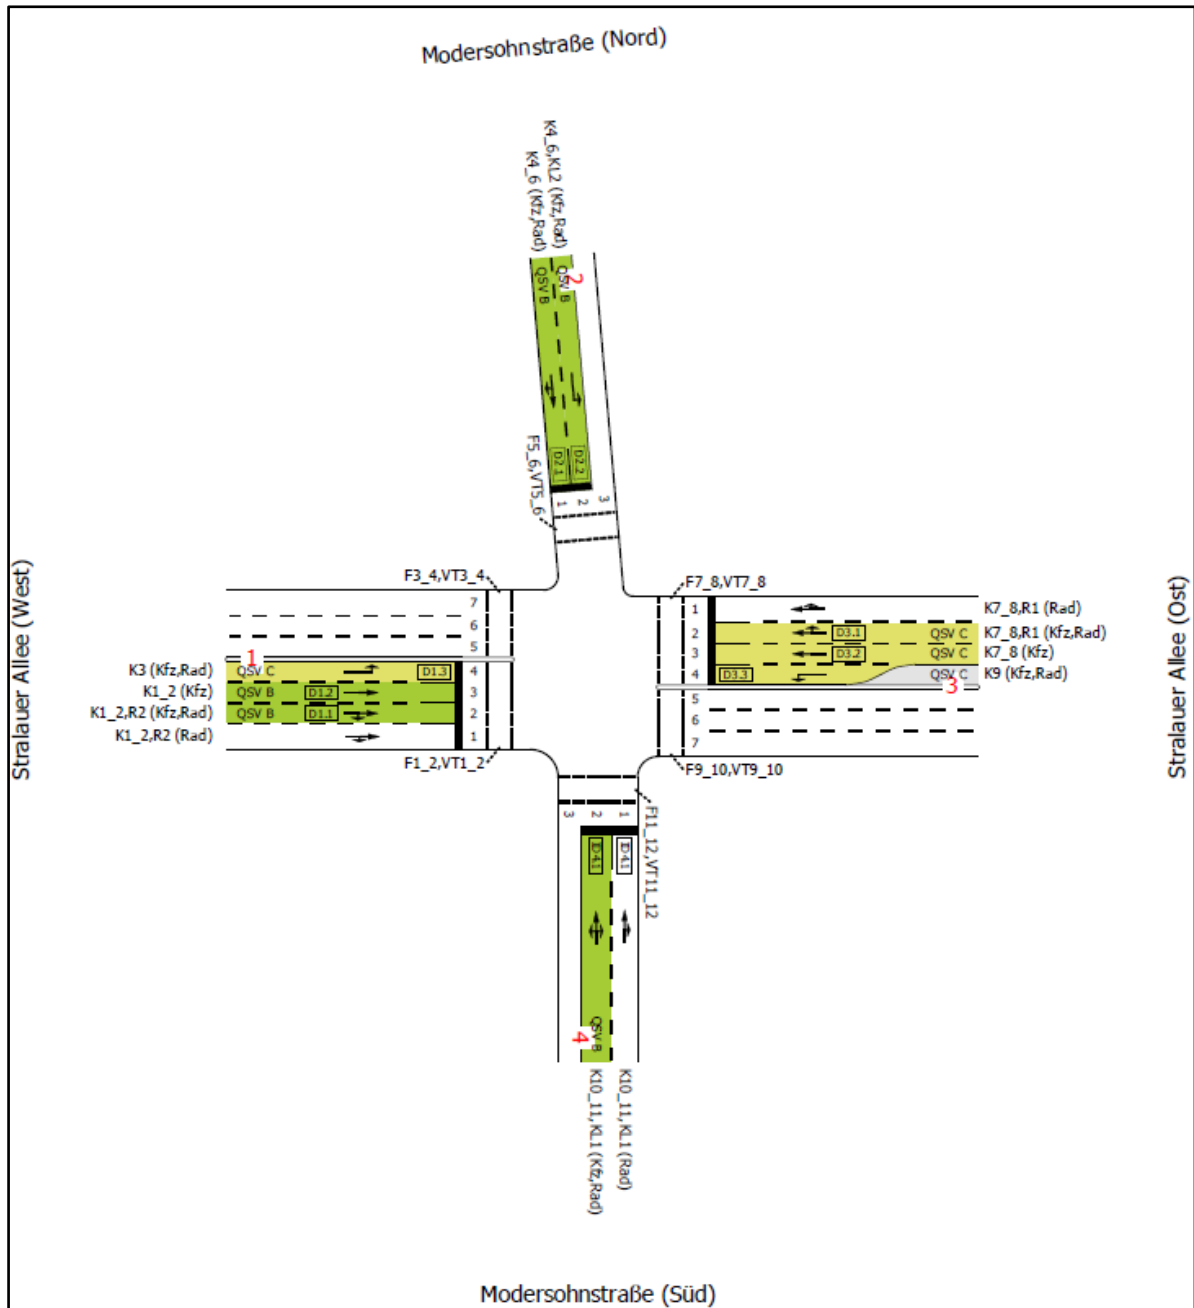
KP Stralauer Allee/ Modersohnstraße HBS-Bewertung Planfall 2 Spätspitze
